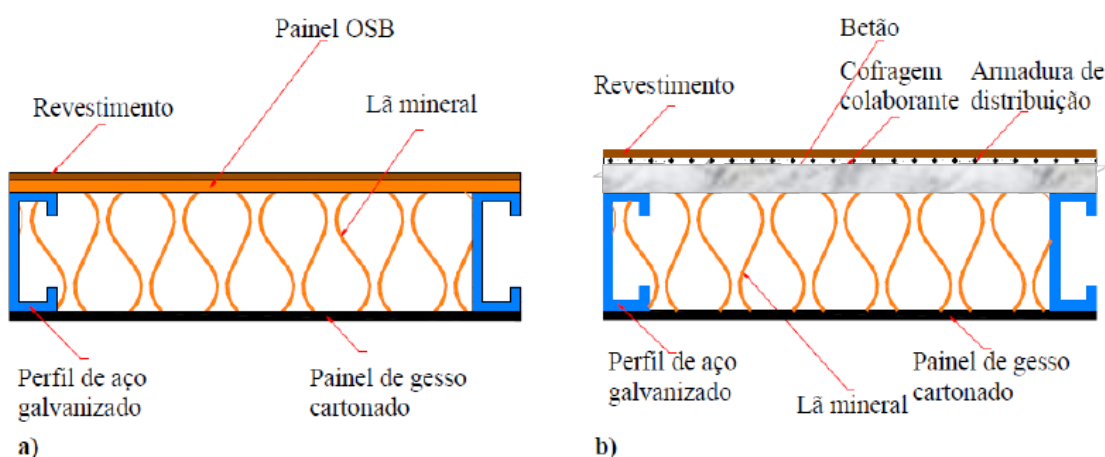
Lajes tipo da solução em LSF: a) solução para laje de cobertura; b) solução para laje entre pisos (Neves, 2011).
